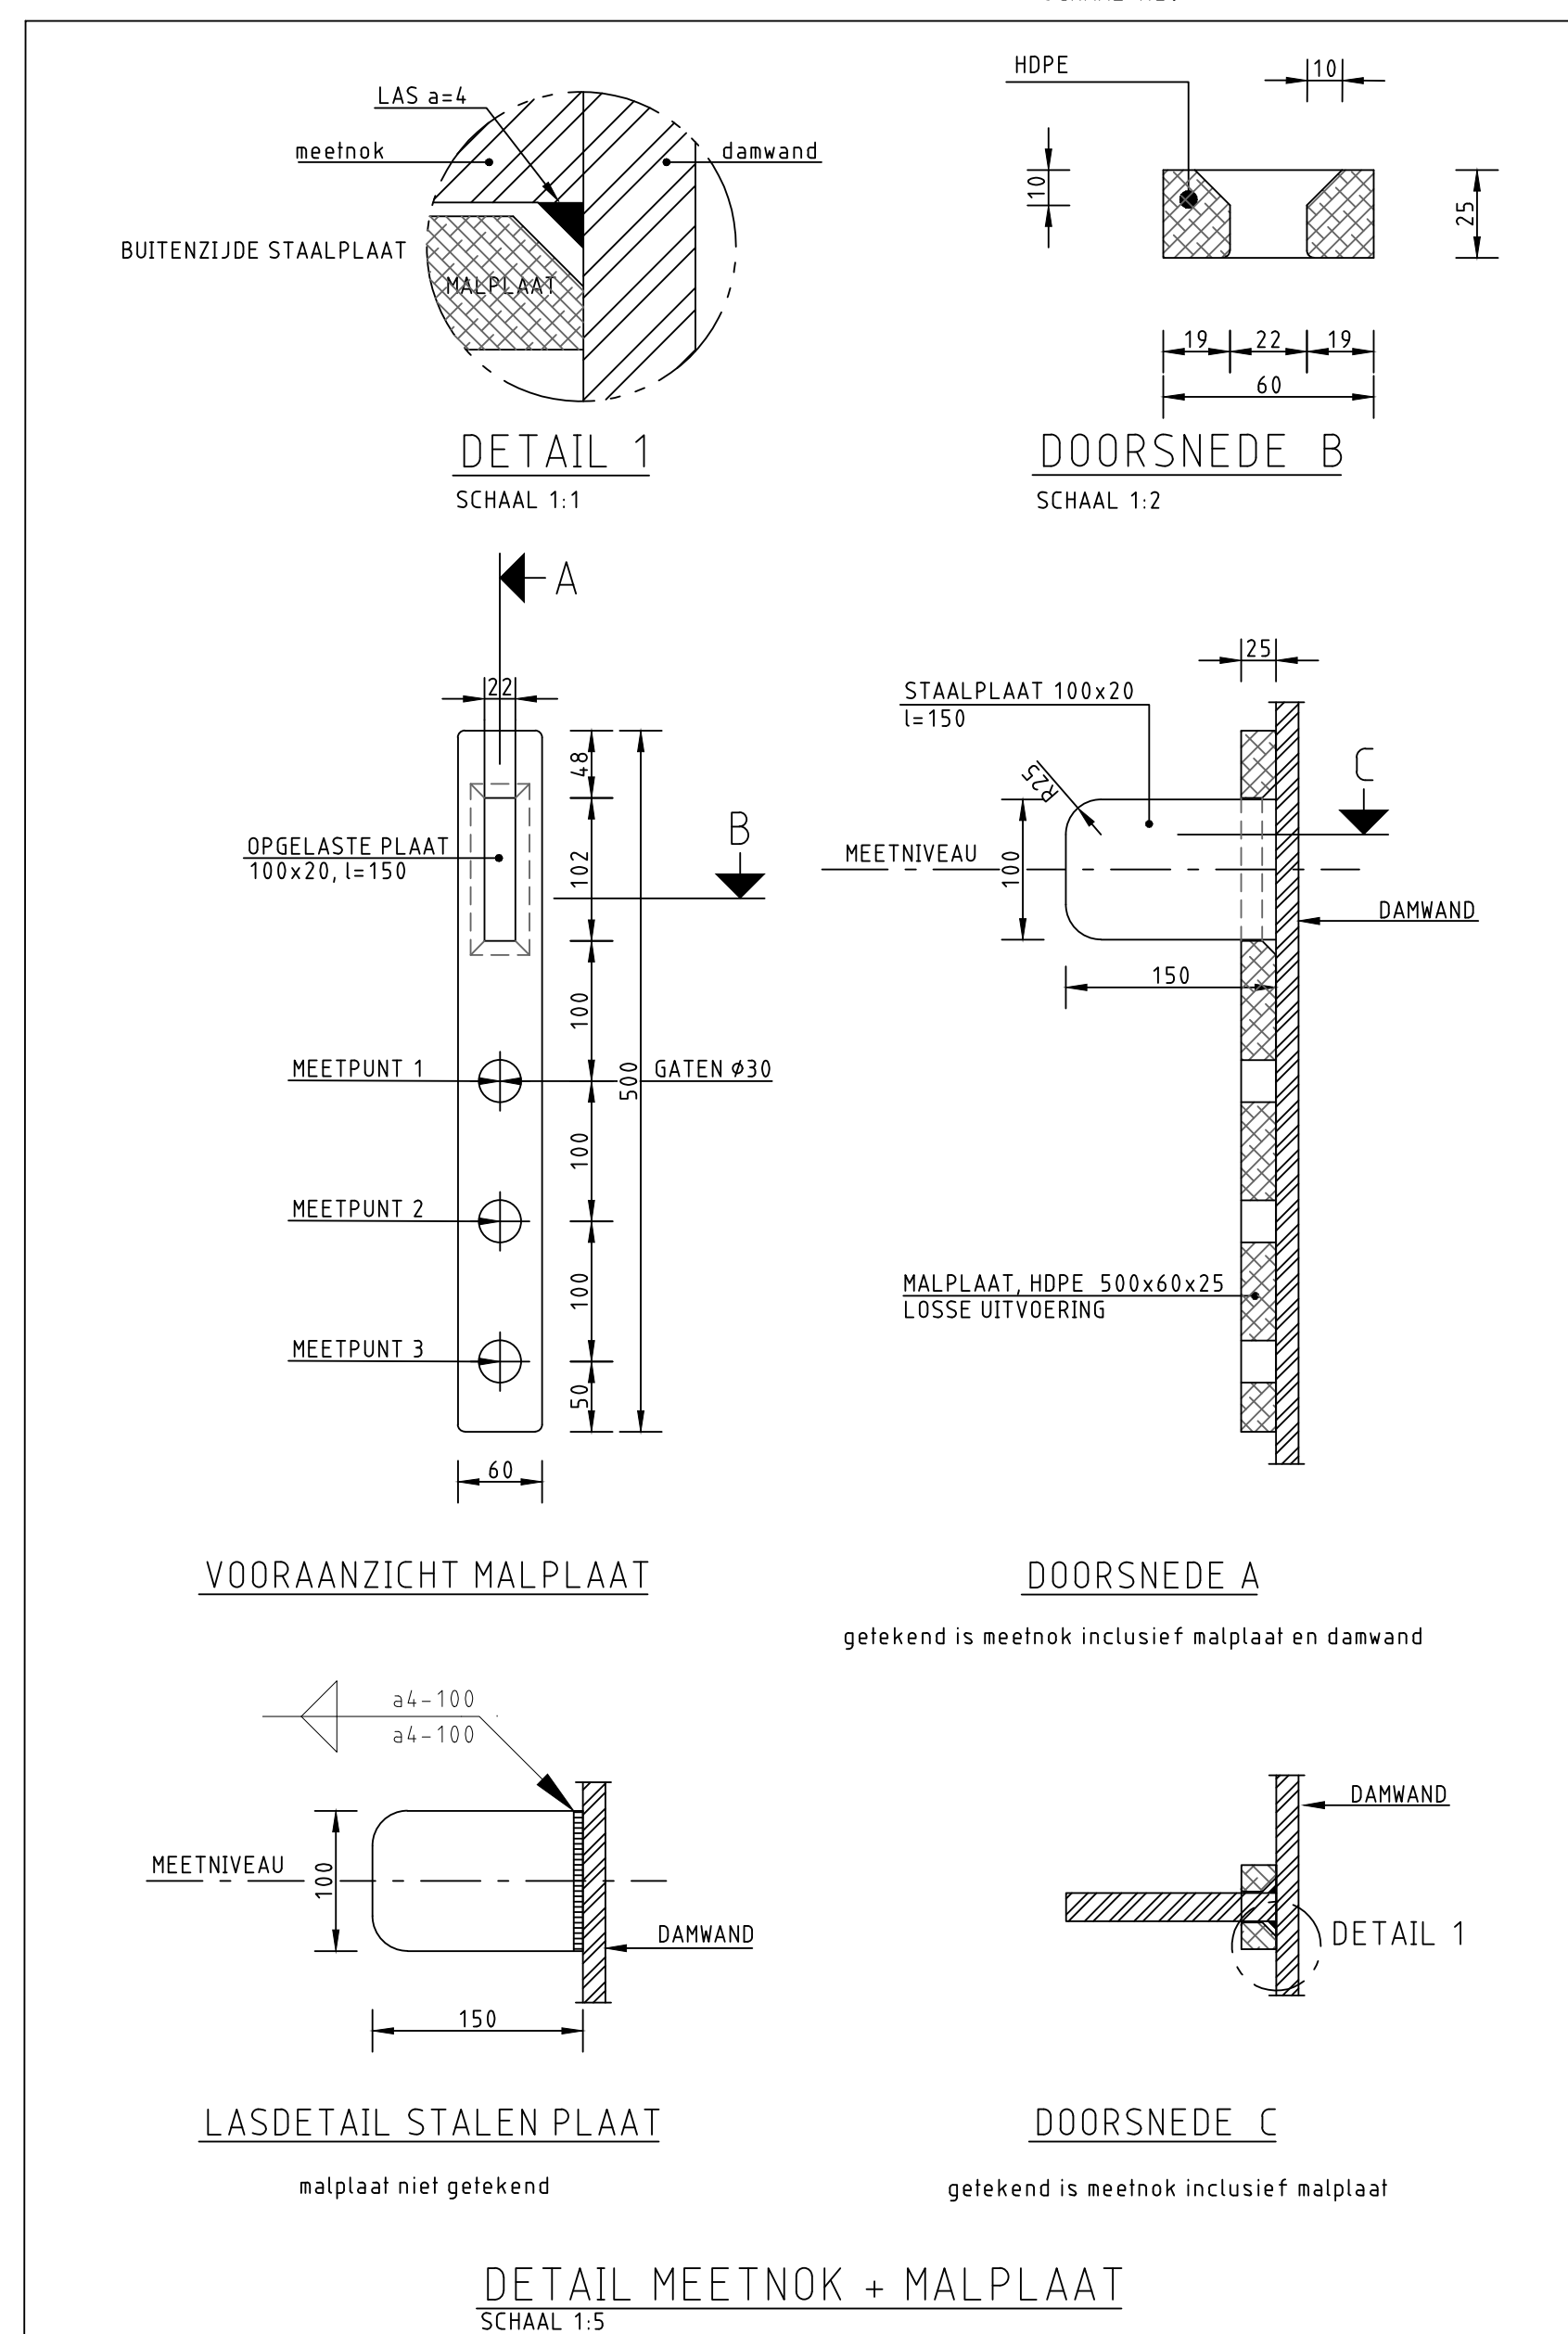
DETAIL MEETPUNT WANDDIKTE-CONTROLE METING
